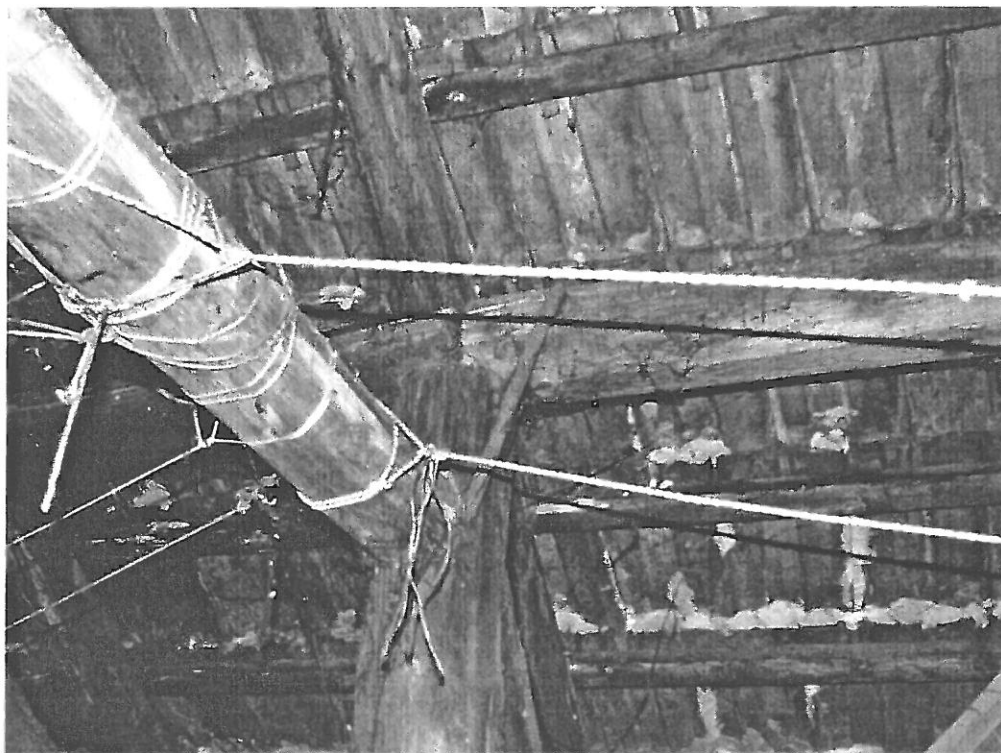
Widok na miejsce ugięcia się stropu nad piętrem I.
